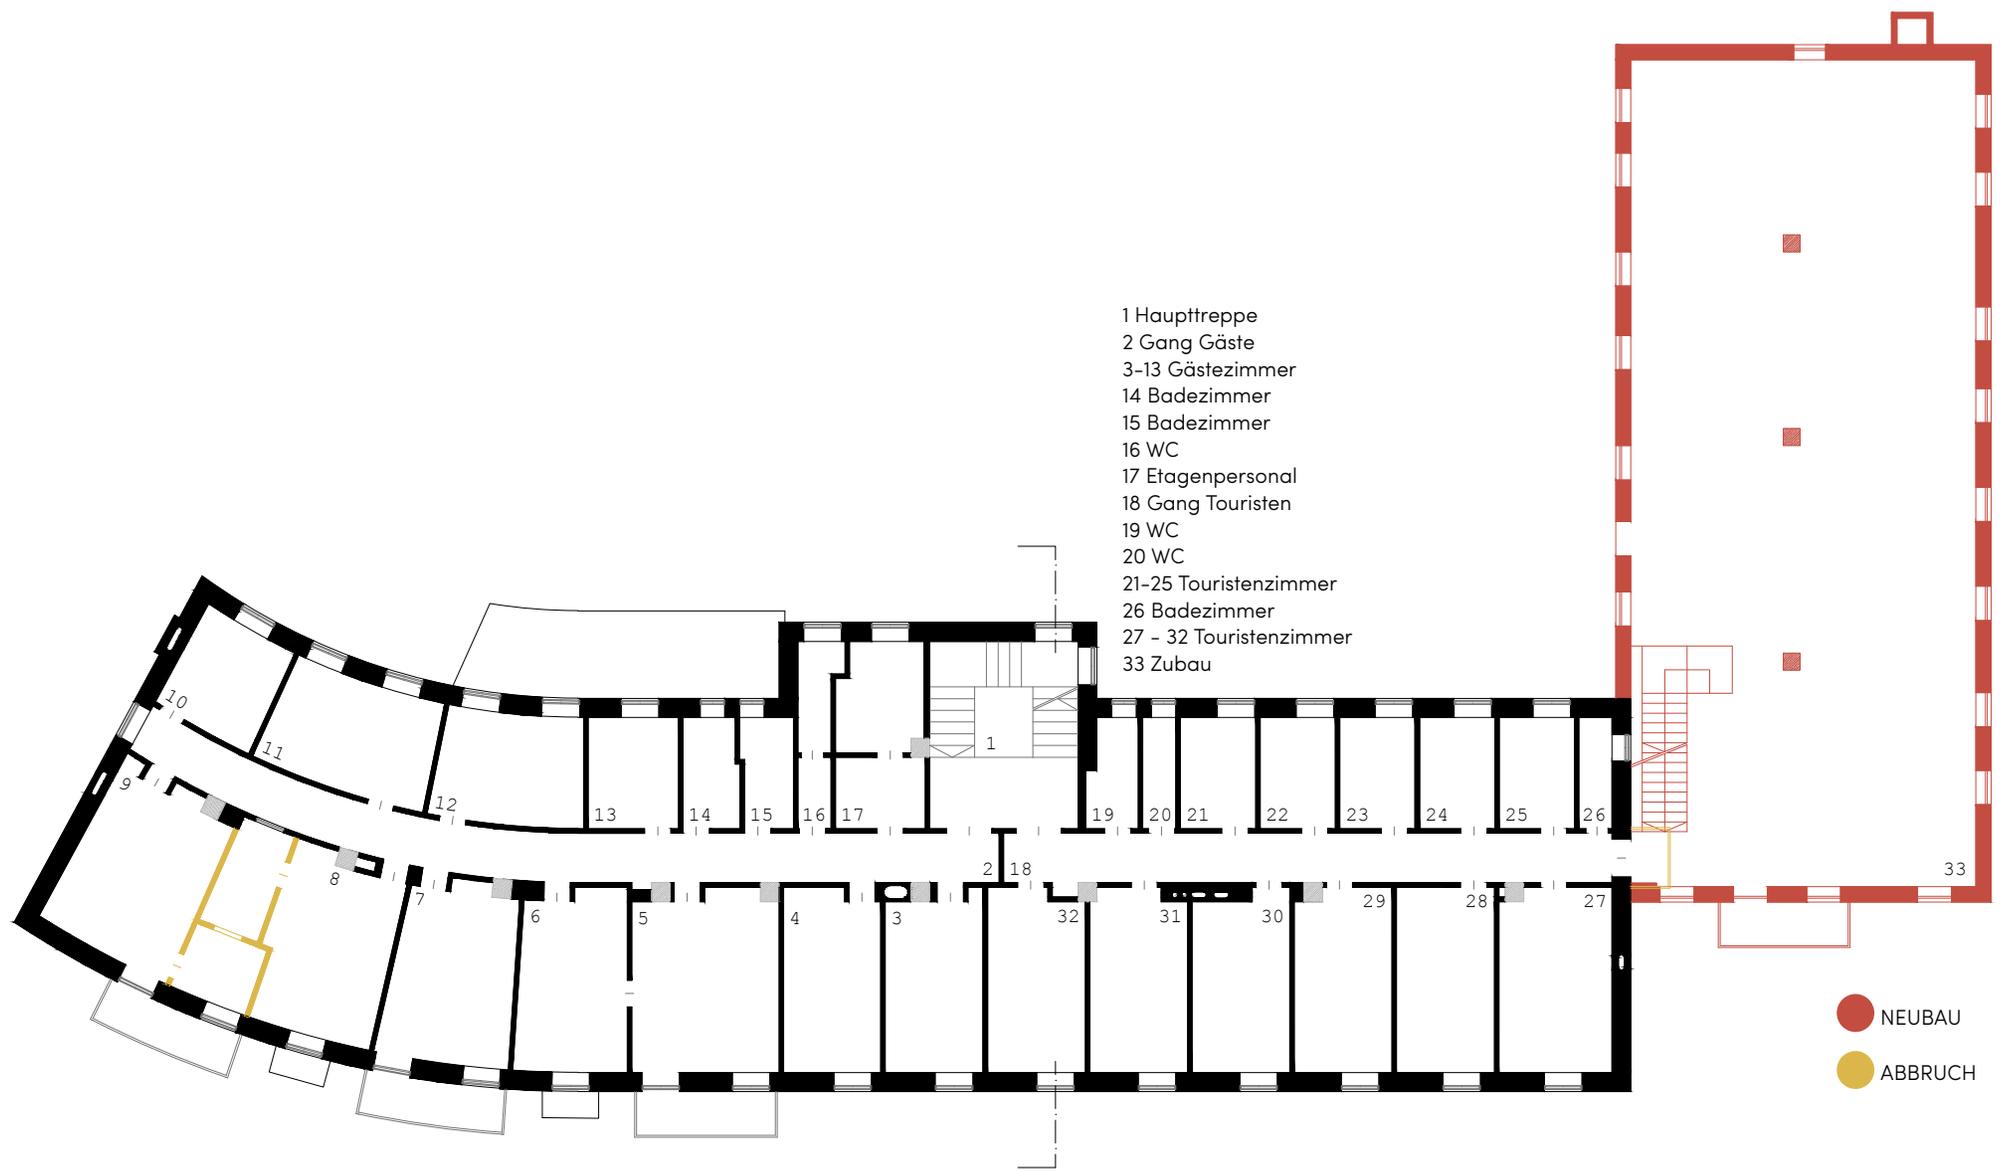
Grundriss 1. Obergeschoss 1:200
